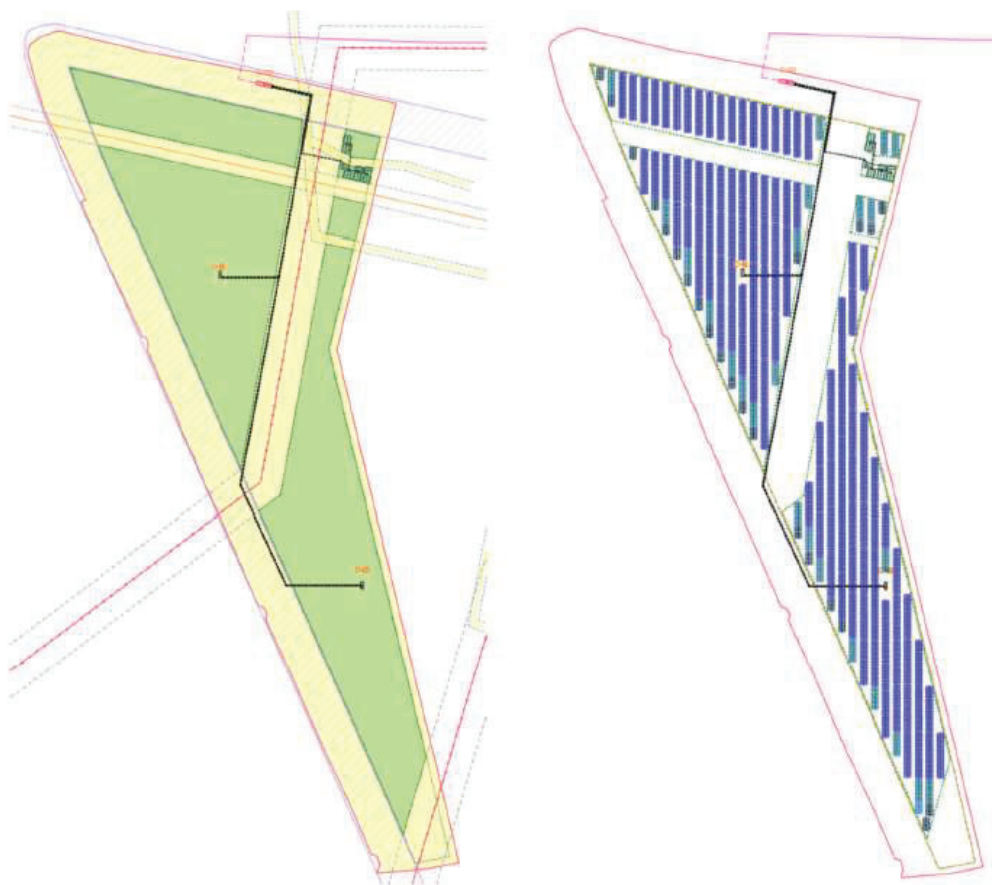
Definizione del lotto e schema dell'impianto fotovoltaico
